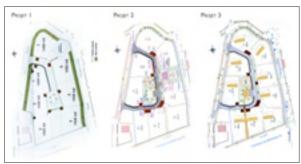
Bernadets – Plans DEGEORGES & LABOUDETTE GÉOMÈTRES
